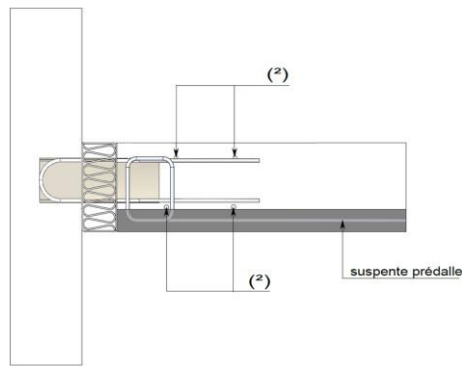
Chainage en rive de plancher – liaison dalle à prédalle -façade – disposition 3 (vue en coupe)
